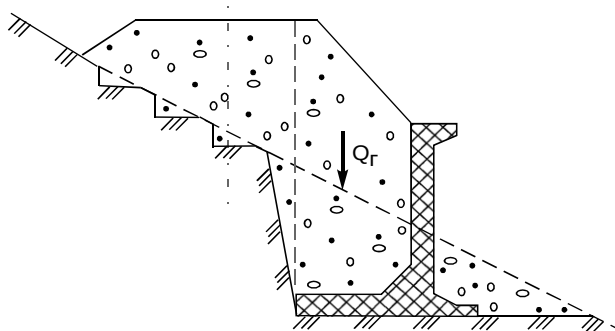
Подпорная углового типа железобетонная стенка сборной конструкции
